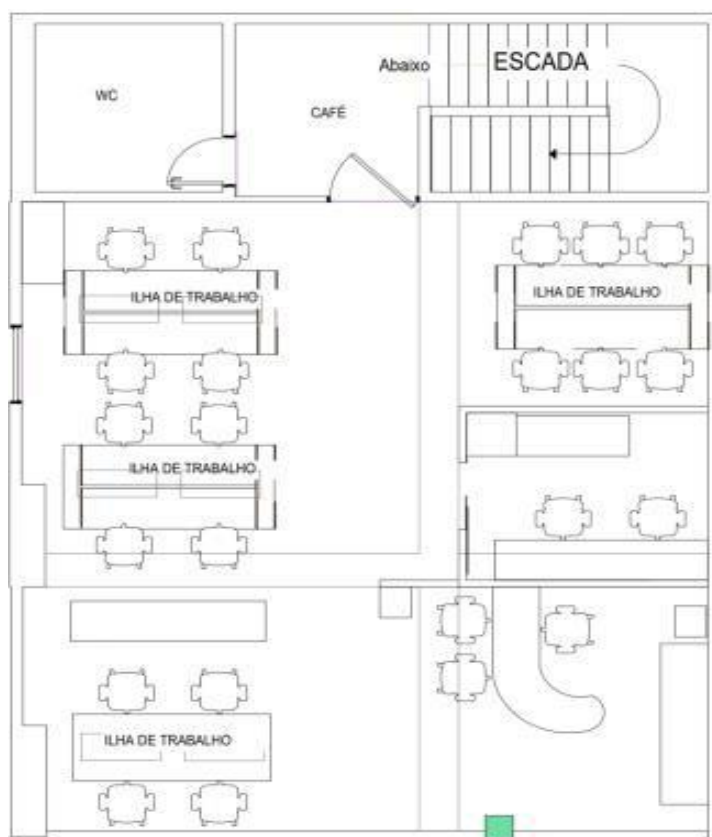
Planta baixa. Fonte: Adaptado de Colaborativa HUB, 2025
